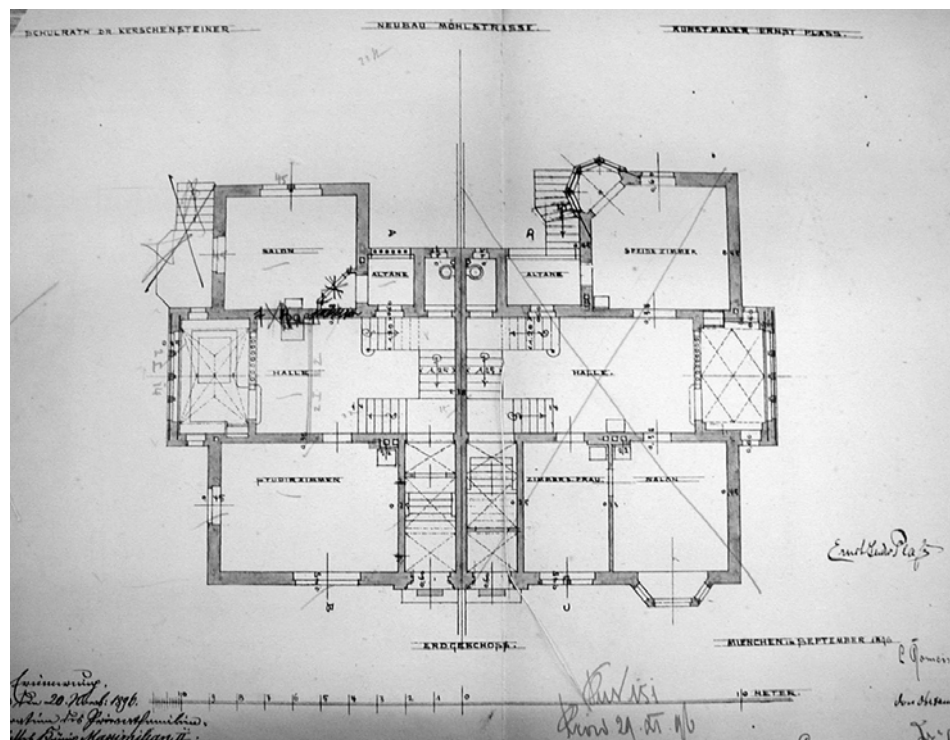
Doppelvilla Plaß/Kerschensteiner, Grundriß Erdgeschoß, Leonhard Romeis, 1896, Plan nach Westen ausgerichtet.
